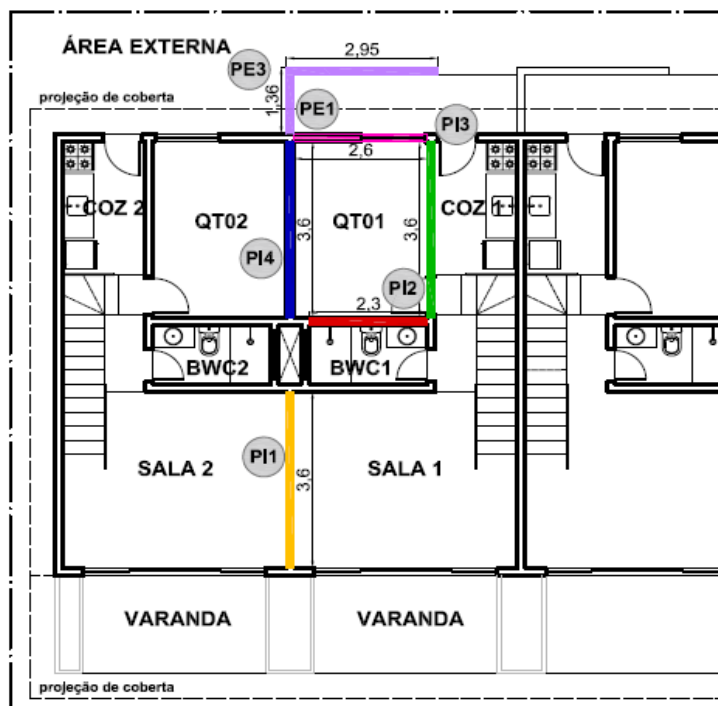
Planta baixa do Objeto 02 (pavimento térreo) com as paredes avaliadas nos ensaios em campo.
